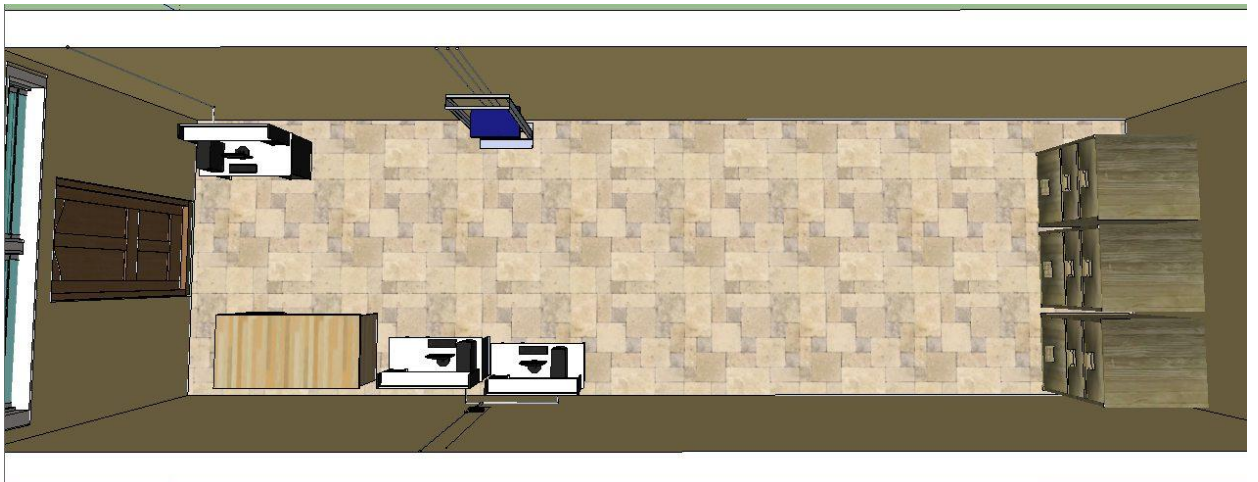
J: Vista en planta de la Sala de Educación a Distancia
